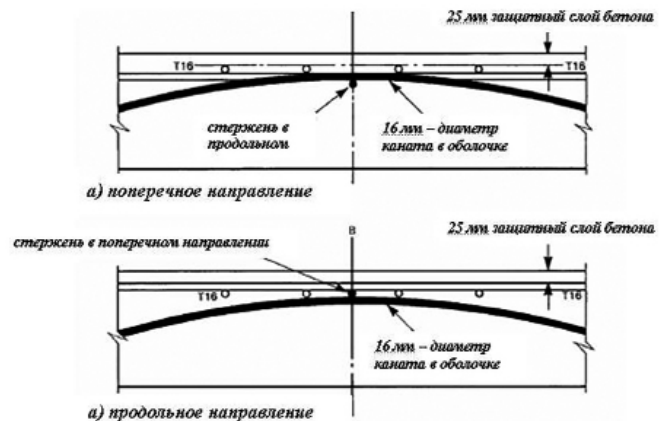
Взаимное расположение напрягаемых элементов и ненапрягаемой арматуры при армировании плит перекрытий в двух направлениях: а) поперечное направление; б) продольное направление
